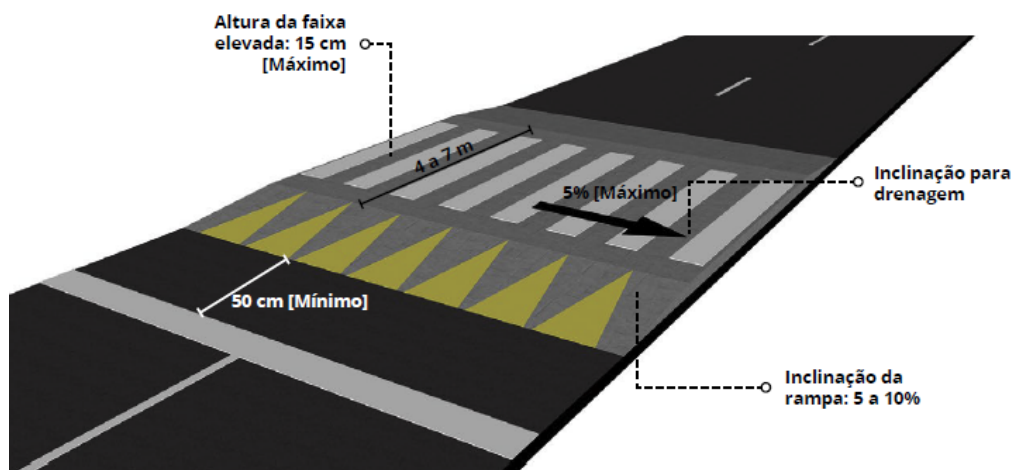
Faixa elevada de pedestres – recomendações para projeto
